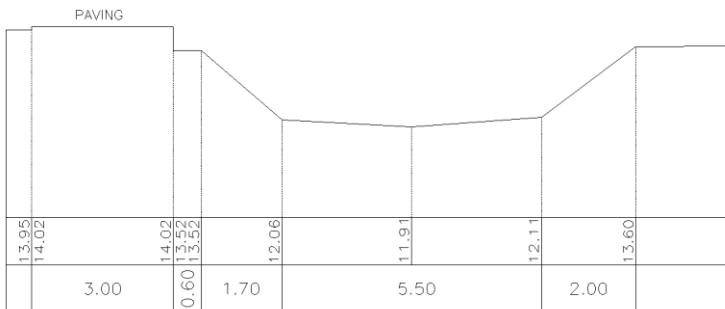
Penampang Memanjang Existing *Afvoer* Kemambang
